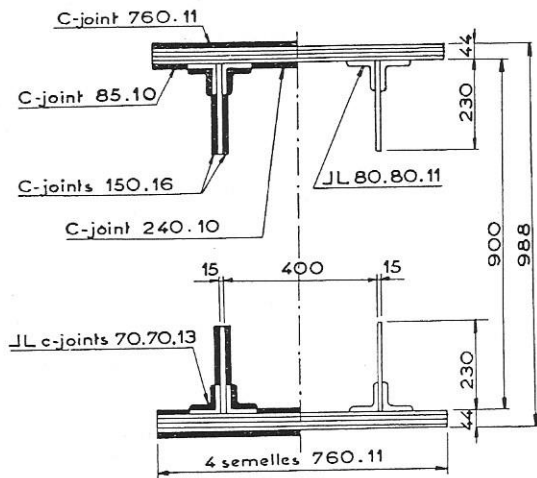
Section transversale dans un arc de l'arche centrale au droit d'un joint (à gauche) et hors d'un joint (à droite). (Couvre-joints en noir.)
